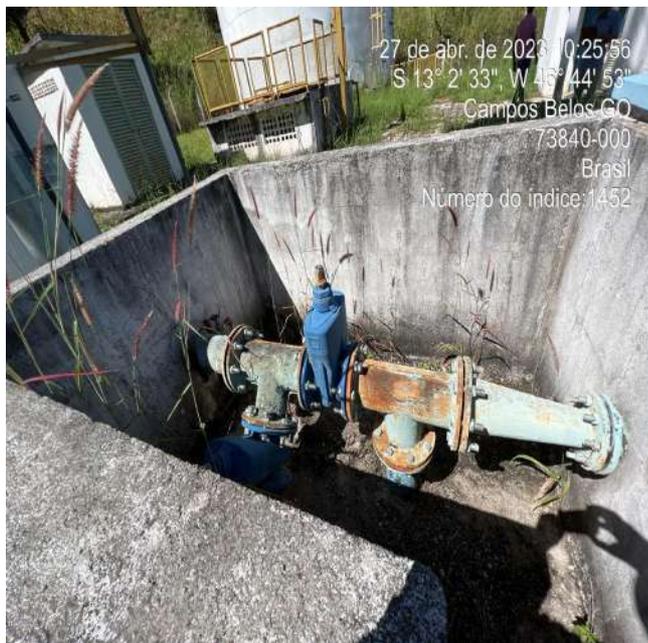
Caixas de passagem sem tampa ou grade de proteção.
